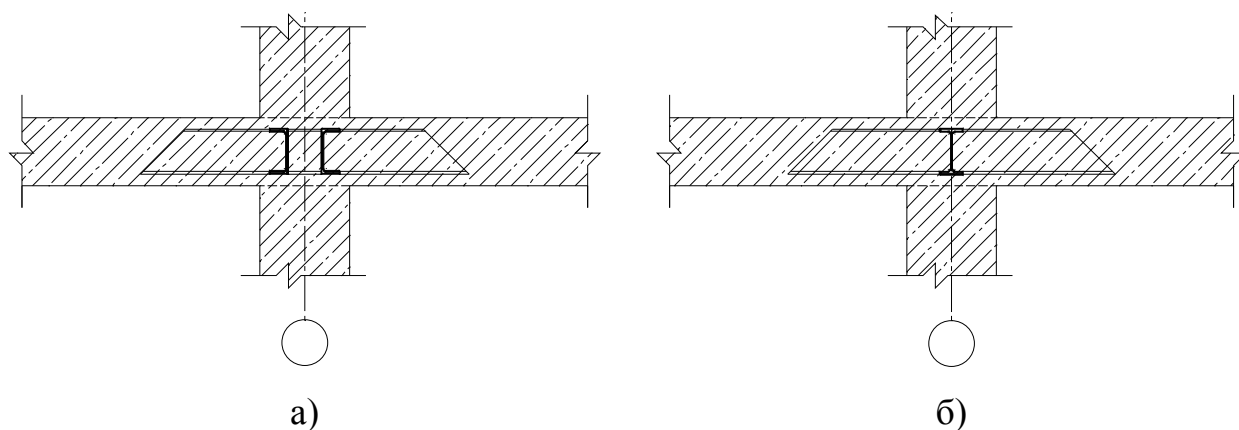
Опорная зона безбалочного перекрытия с жёсткой арматурой из швеллеров – а), из двутавров – б)
